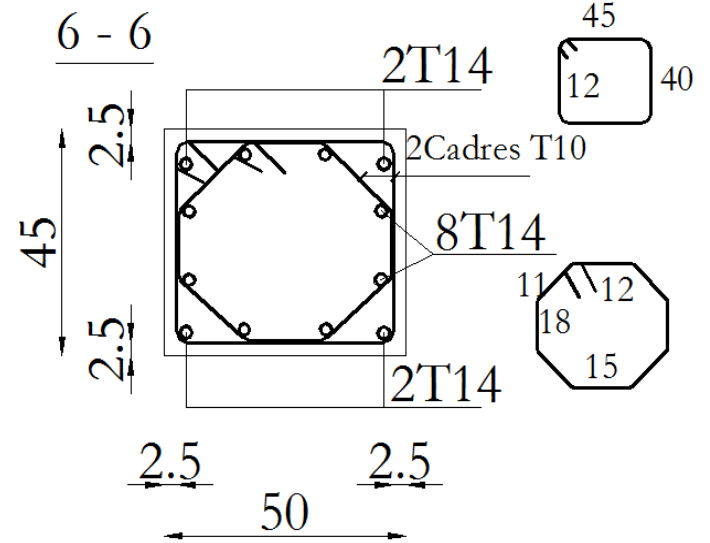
Ferrailage des poteaux 8<sup>ème</sup> étage et cage d'escalier
